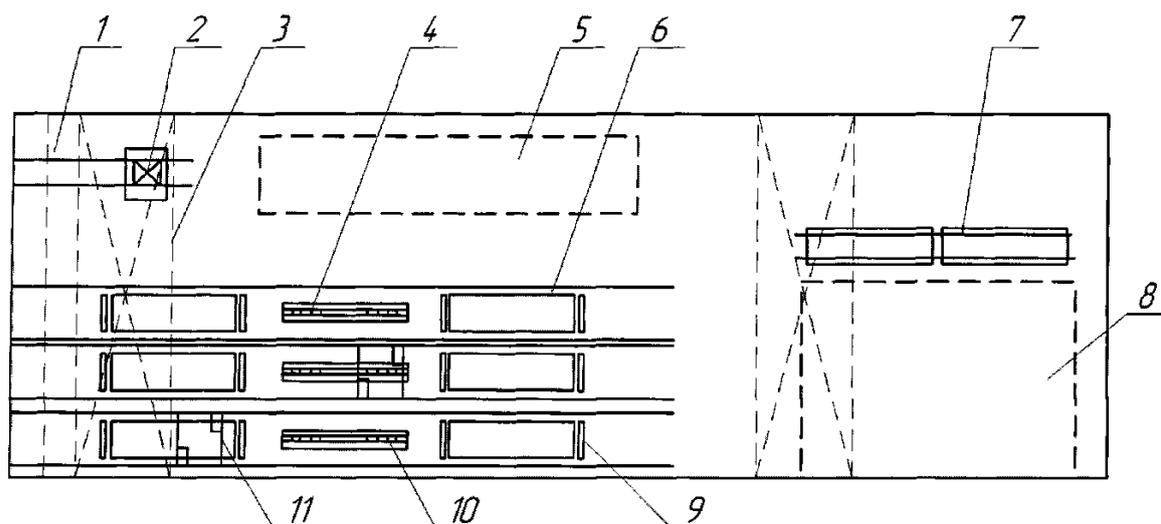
Стендовый способ производства многопустотных плит перекрытий длиной 18 м:
